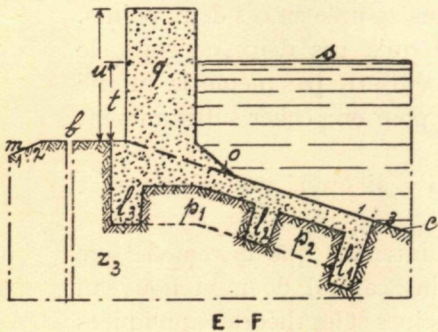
Coupe transversale d'un élément et d'un joint.
